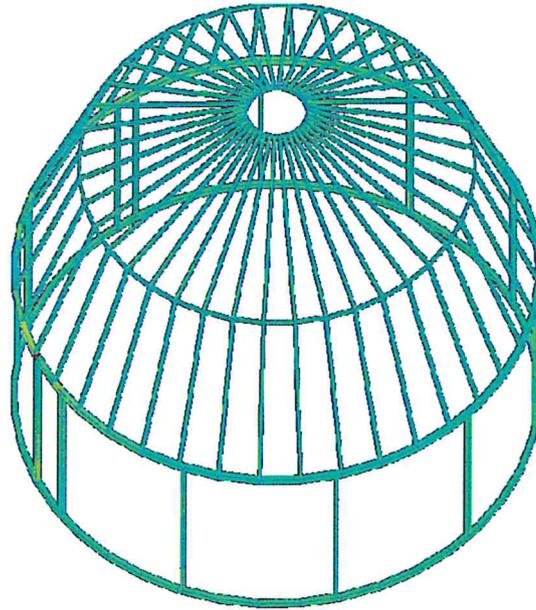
Schema della struttura tubolare. Diametro 6,0 m H=5,2 m
